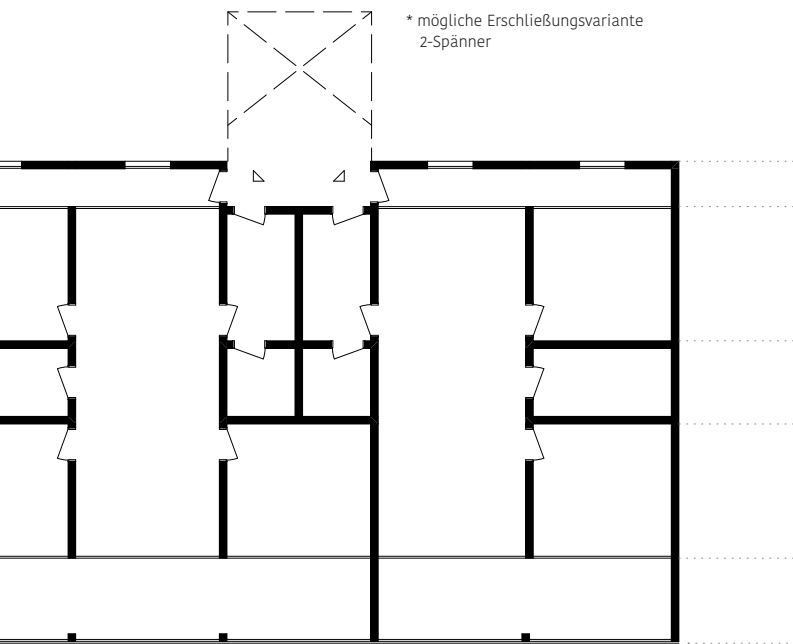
möglicher Regelgrundriss Mischtyp zwei-, drei- und vier Zimmer
